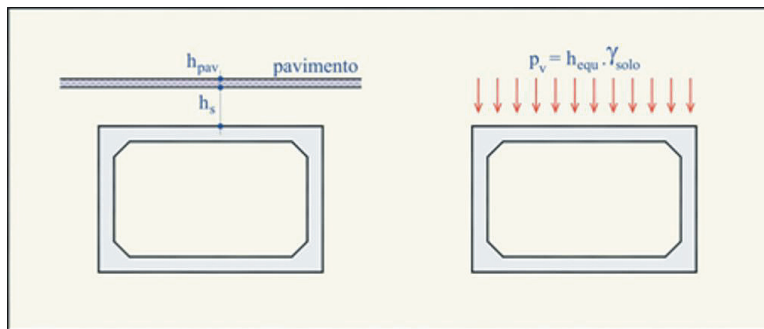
Pressões verticais do solo e do pavimento sobre a galeria
